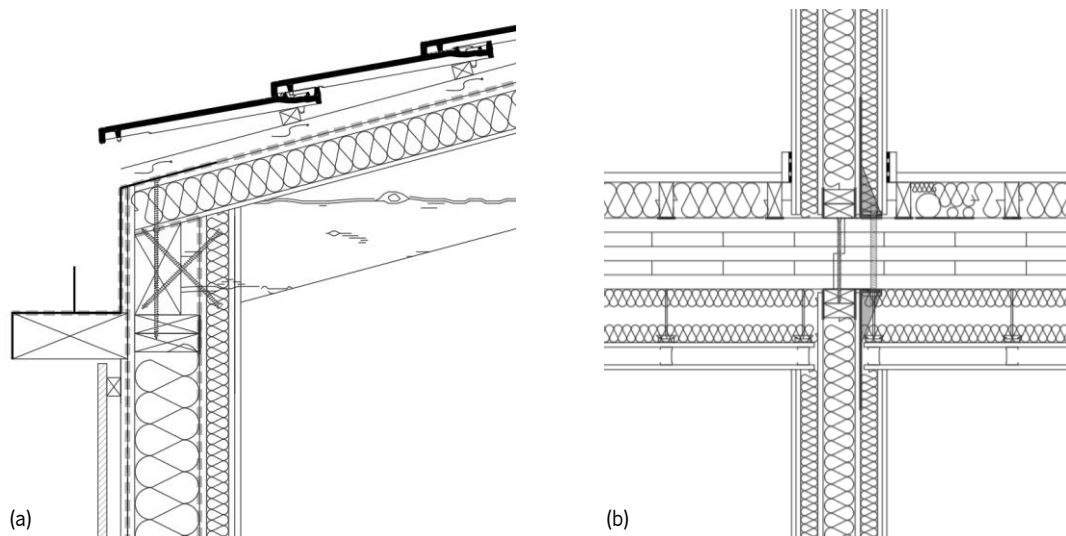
(a) Junção entre as vigas da Cob_TAH e as vigas de coroamento; (b) Parede não estrutural apoiada diretamente sobre o CLT do piso intermediário. Exemplo: Par_Int_Nest_TF e Pav_Int_CLT
